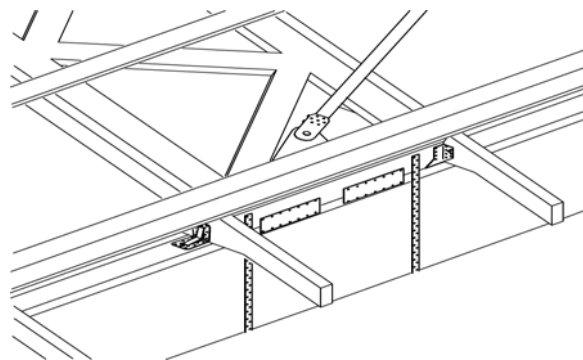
Anbindung einer Dachaussteifung an eine Wand (System: Simpson strong-tie)
